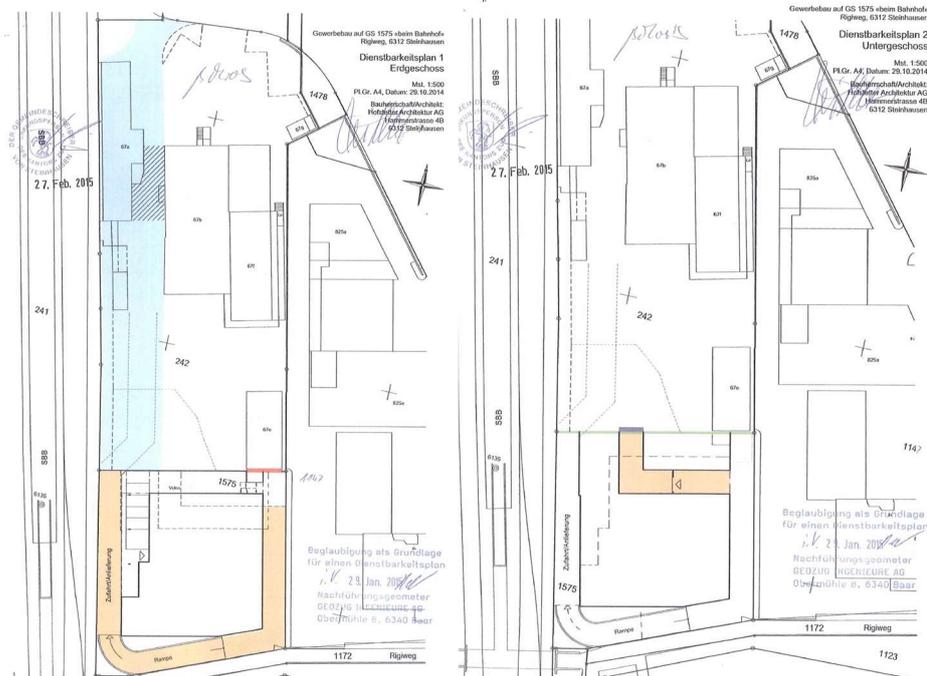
Plan zum Grundbucheintrag – EG (links) und UG (rechts) (Quelle: Grundbuch)
